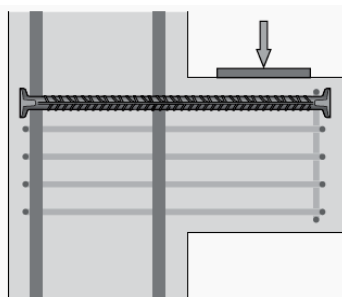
Alternatywny sposób zbrojenia wspornika z przykładu 4.1 (por. rys. 4.9)
